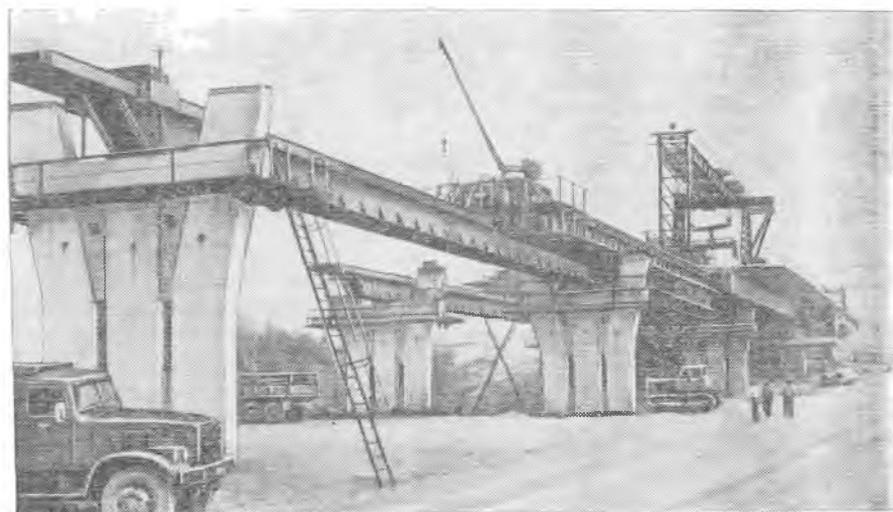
Монтаж неразрезных пролетных строений по 42 м на перемещаемых подмостях на береговых участках эстакады моста через р. Днепр
